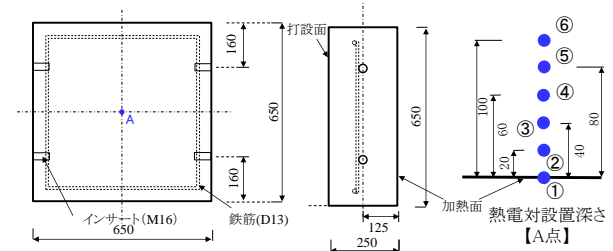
試験体の形状、熱電対の設置位置(単位：mm)
